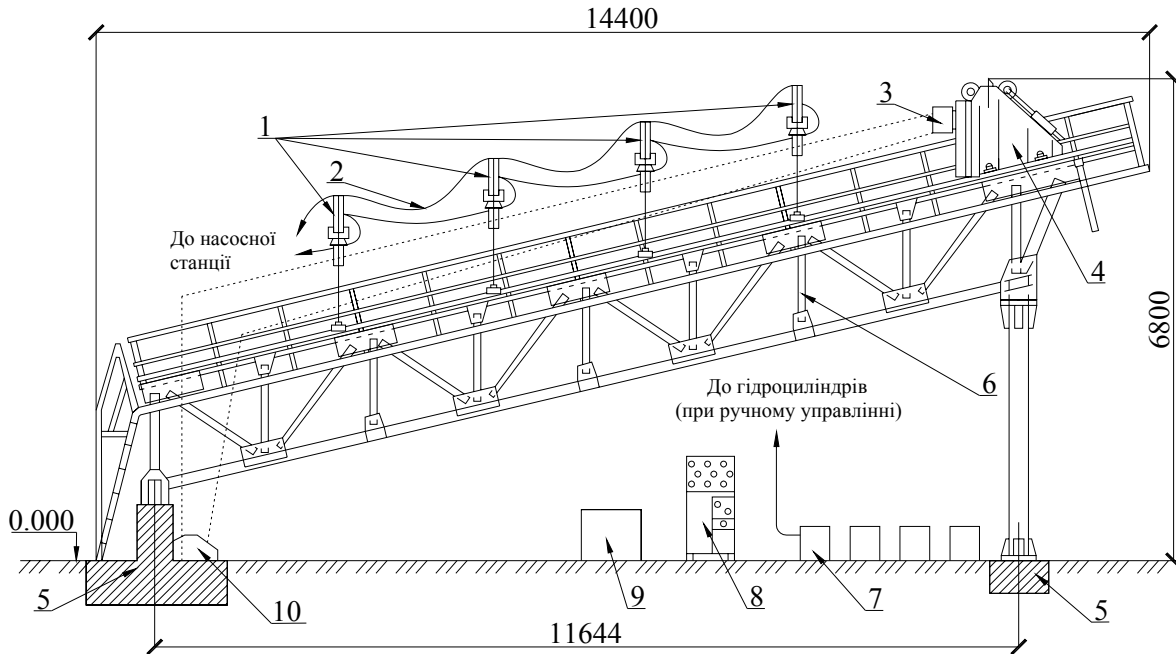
Стенд для досліджень рамних конструкцій:
